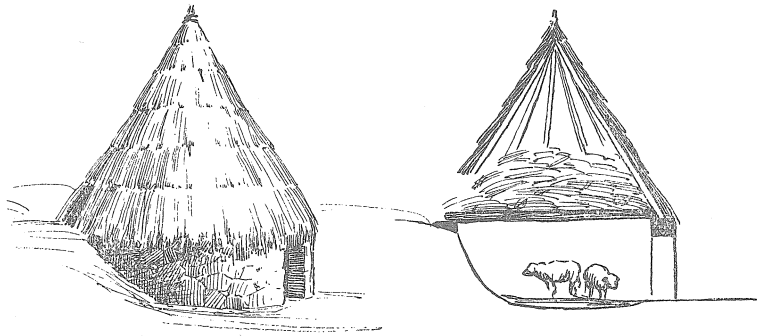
Construção cilíndrico-cónica de Prime (Fragozela, Viseu), e o perfil da mesma construção, onde se vê a porta do curral em baixo, e a entrada do palheiro aberta no próprio telhado.
